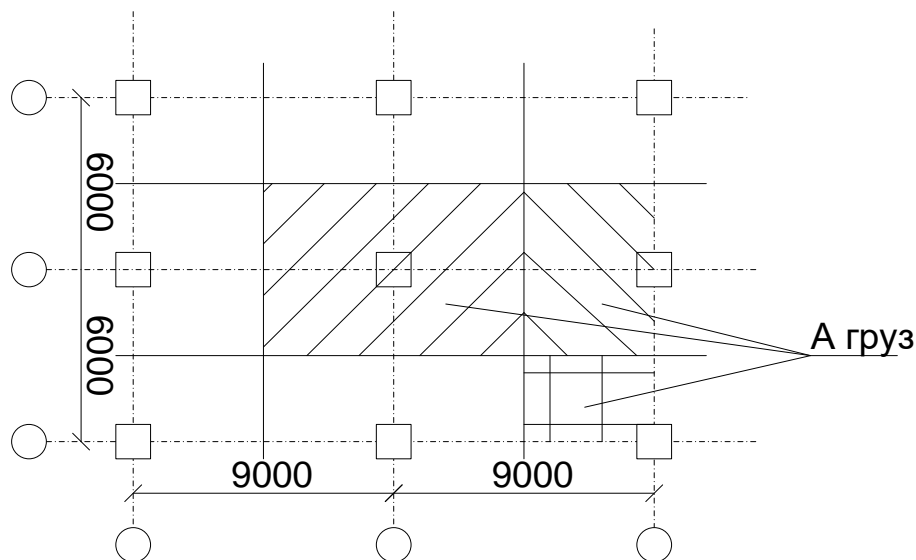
Схема определения грузовой площади для сбора нагрузок для зданий с рамным каркасом на фундамент под колонну:
